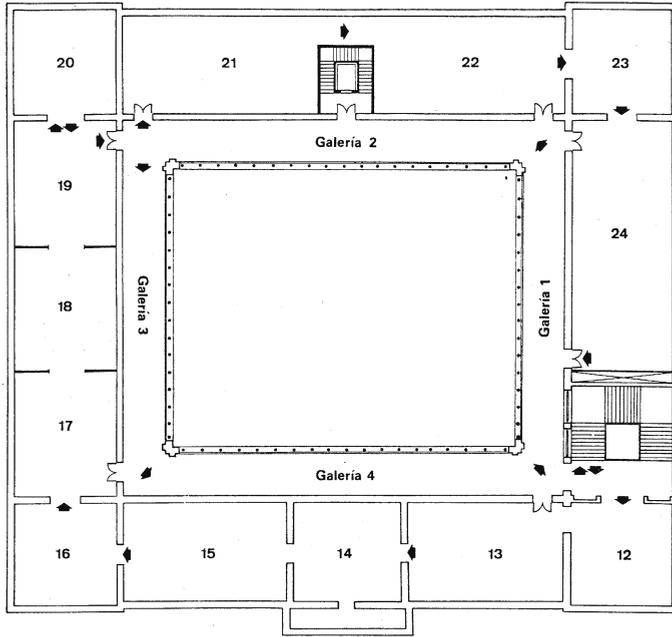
Museo de Zaragoza. Reforma de 1974. Planta baja. Sección de Arqueología.
